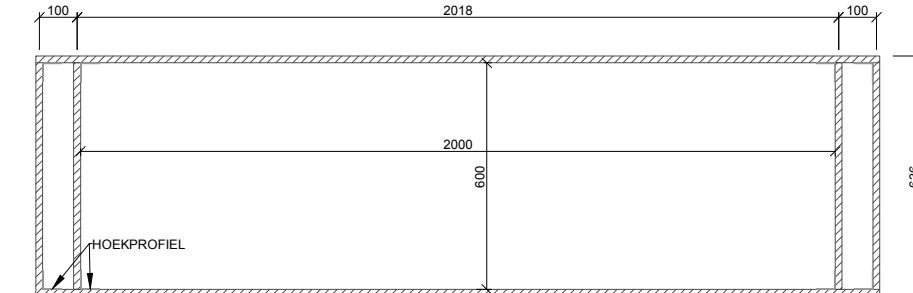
BEVESTIGING ONDERKANT PROEFOPSTELLING
